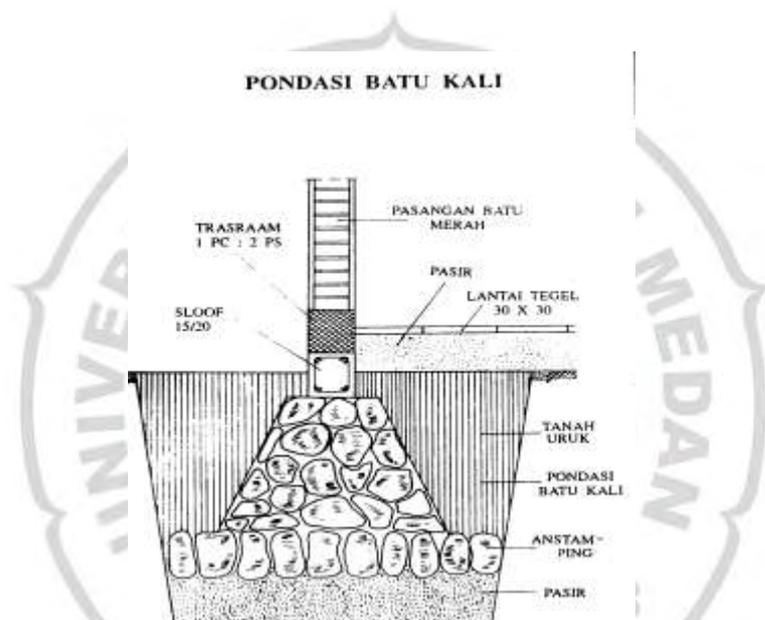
Denah Pondasi Suatu Bangunan
